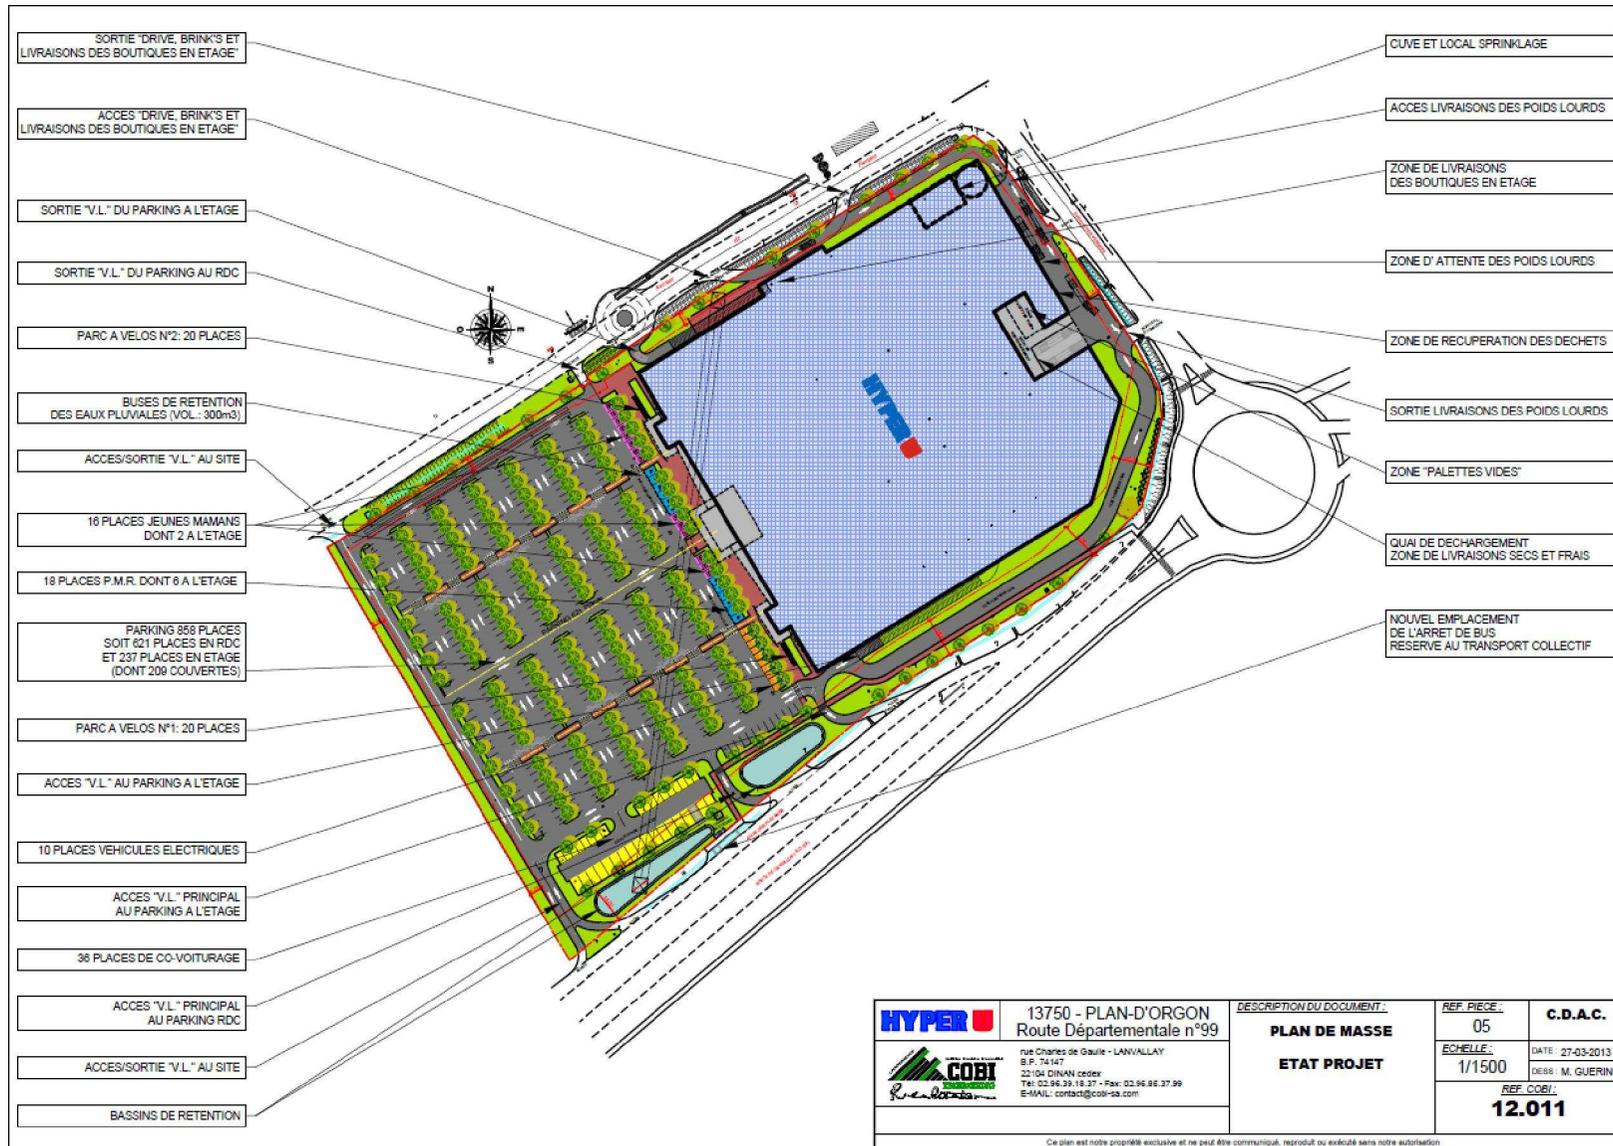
Plan de masse de l'état projet (Source : Dossier CDAC)
